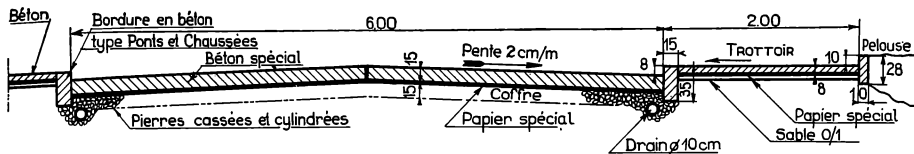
Coupe transversale de la route et des trottoirs en béton (1937).
